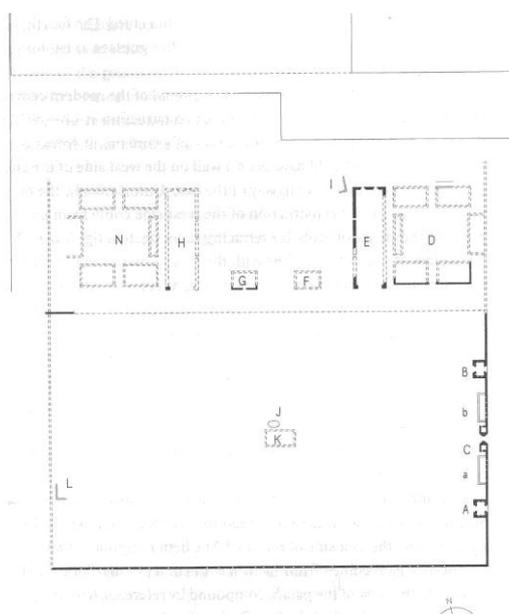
Plano parcial de Yucay das estruturas tipo *kallanka* (H e E); agrupações *kancha* (N e D) praça principal (K e L) amuralhada com torreones de controle A, B e C e estruturas associadas (a e b) Yucay, Cusco.
